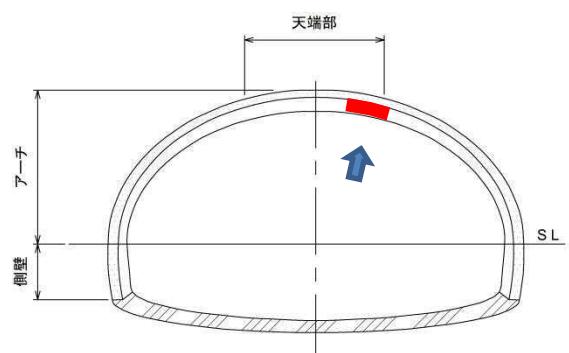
色むら・打重ね線に沿って発生したひび割れ
